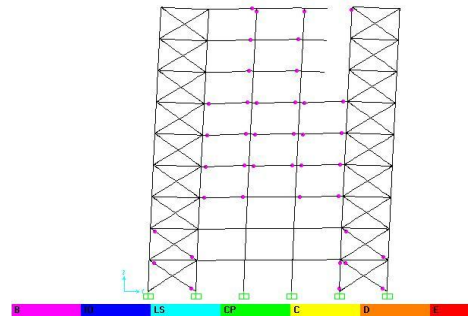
SRPMK lantai 10 arah X step 4 (Sumber Permodelan Sap2000)
